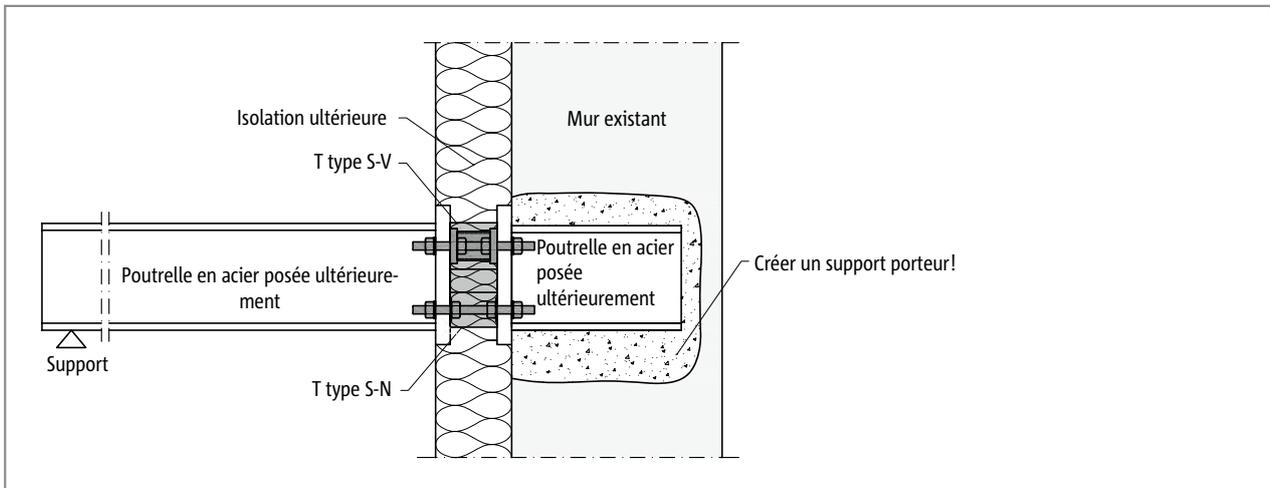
Schöck Isokorb® T type S-N et T type S-V : balcon en acier soutenu posé ultérieurement ; raccordé à un support mural posé ultérieurement
